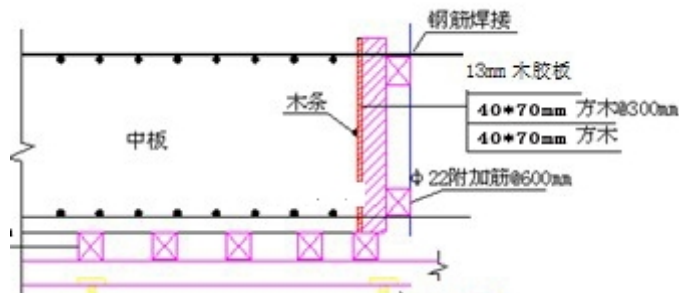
中板施工缝端头模板及支撑体系剖面图
